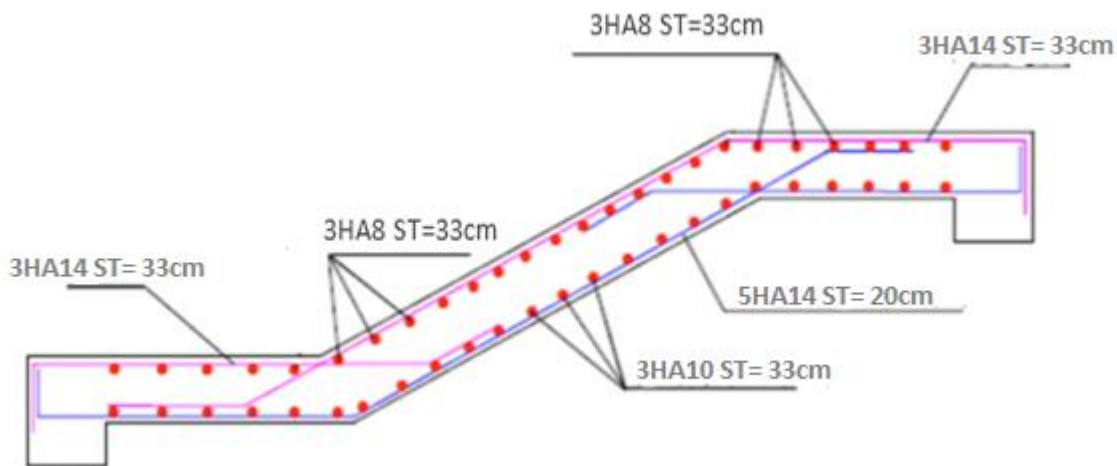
Schéma de ferrailage de l'escalier étage courant
